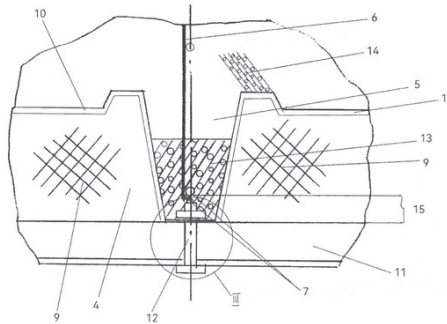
Узел II на рис. 2, крепление листового огнезащитного материала к кессонам снизу несъемной опалубки, размещение арматурного каркаса в кессоне и огнезащитного материала в пустотах [6], где: 4 – пустоты; 5 – кессоны для заполнения бетоном; 6 – арматурный каркас; 7 – арматура; 9 – огнезащитный материал; 10 – огнезащитная поверхность; 11 – листовой огнезащитный материал; 12 – цанговый зажим; 13 – нижний слой из тяжелого бетона; 14 – верхний слой из легкого бетона; 15 – защитный слой.
